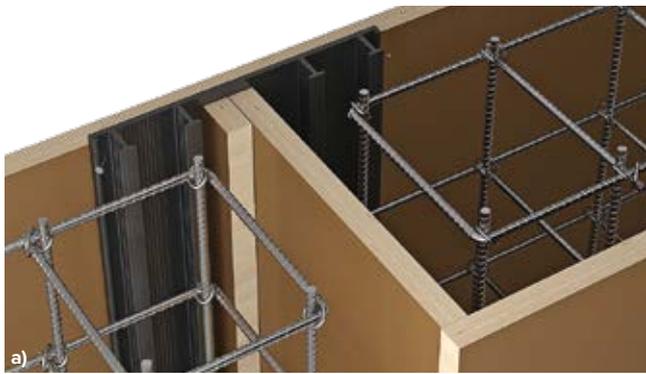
Этапы работ по установке гидрошпонок серии ТН Фундамент ТШН
